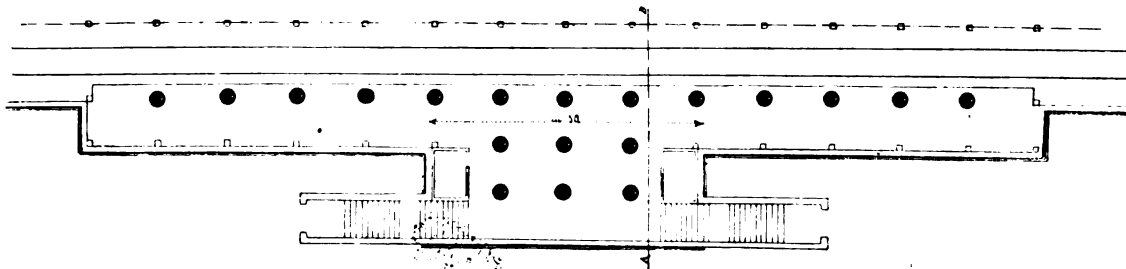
Stazione sotterranea di passaggio. - Pianta.
